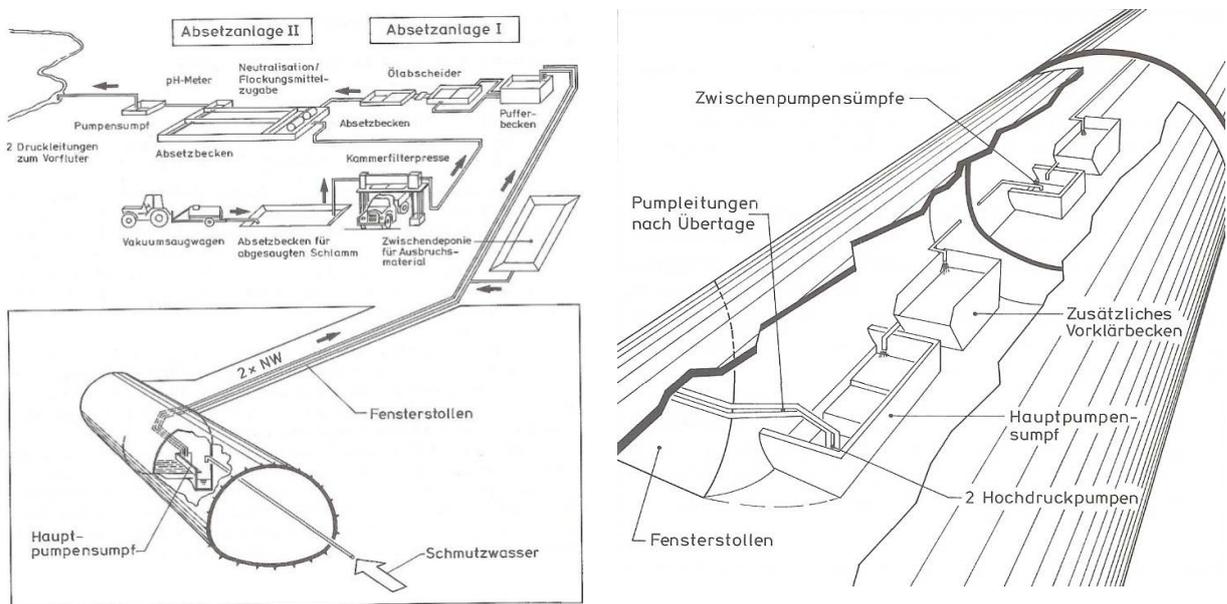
Abwasserreinigung im Tunnelbau¹⁸¹
